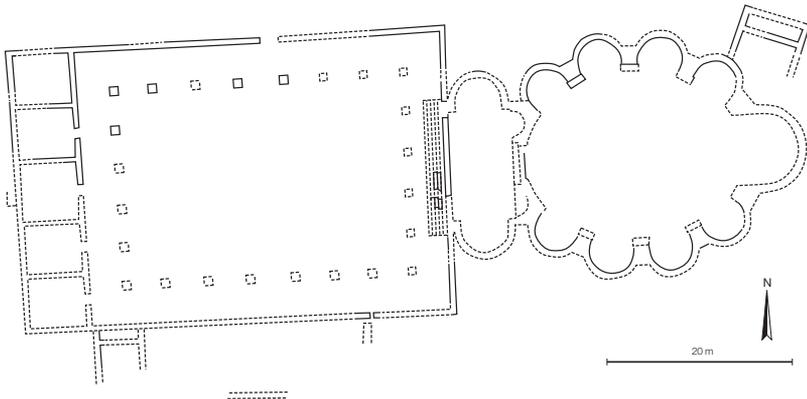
Grundrissrekonstruktion des spätrömischen Bauensembles von St. Gereon in Köln.
